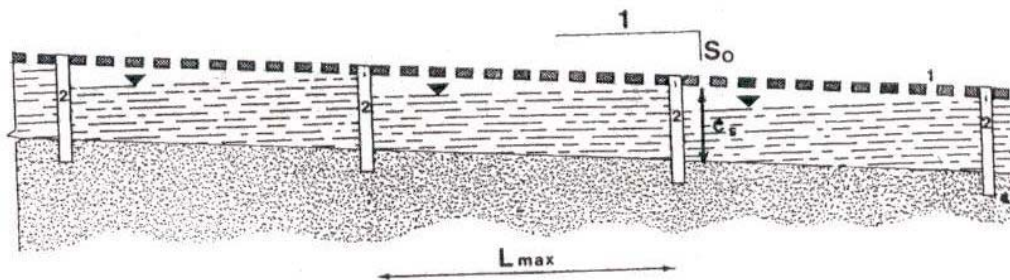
Disposición de separadores en terrenos con pendiente. 1.- Superficie del pavimento, 2.- Separadores, 3.- Subbase, 4.- Subrasante, S_0 : Pendiente, e_s : espesor de la subbase, L_{max} : distancia máxima de los separadores.
